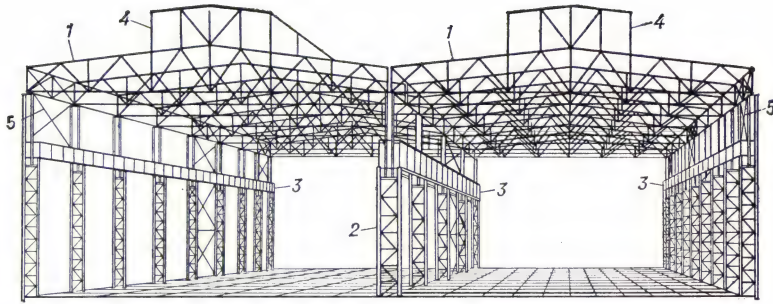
Конструктивная схема стального каркаса двухпролётного производственного здания: 1 — стропильная ферма; 2 — колонна; 3 — подкрановая балка; 4 — светоаэрационный фонарь; 5 — связи.
